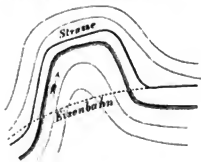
Eisenbahn- und Straßen-Trasse bei starker Talkrümmung.
